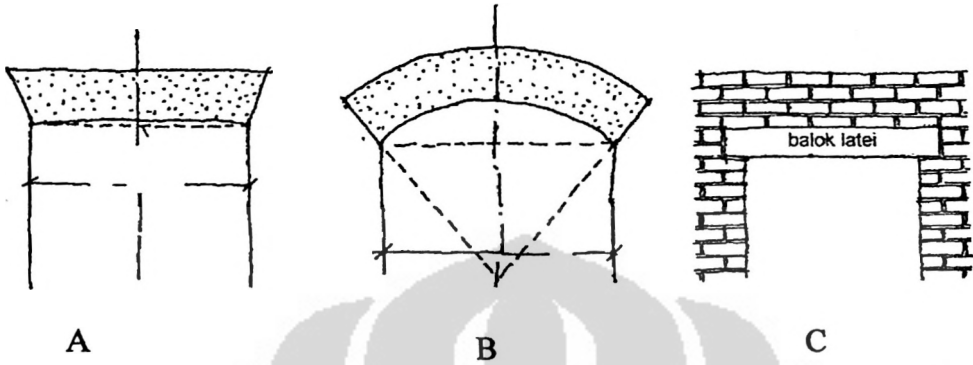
Konstruksi busur landai (A), busur tembereng (B), Balok Latei (C)
